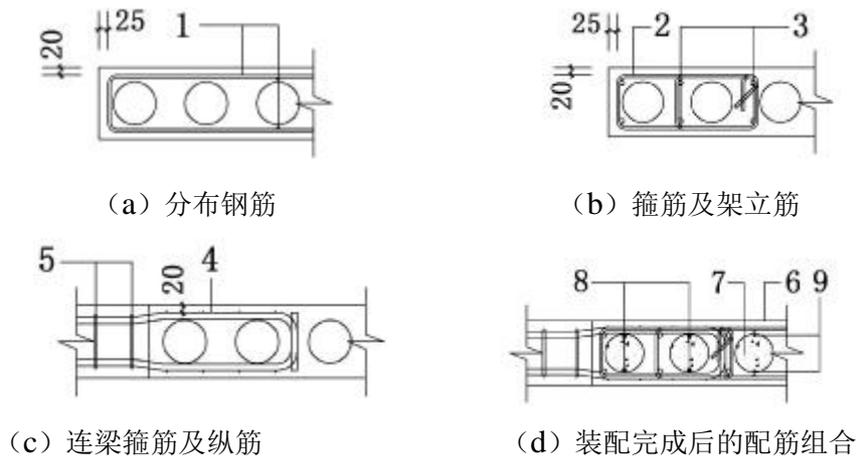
预制构造边缘构件及装配的配筋构造示意
